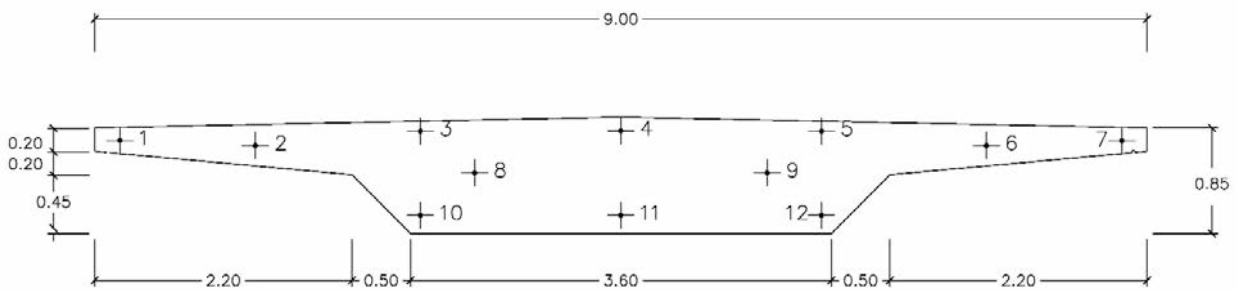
Situación de los sensores en cada una de las secciones transversales instrumentadas
